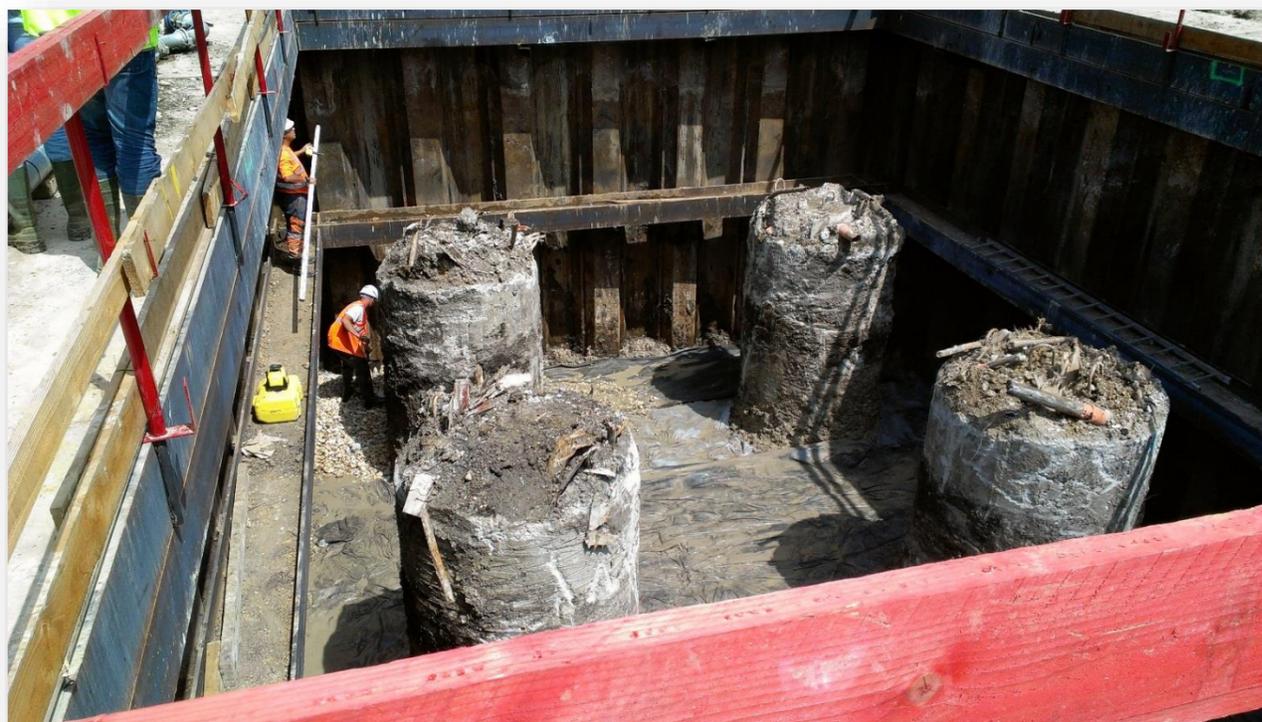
Batardeau pour la réalisation des fondations par pieux forés à sec de la pile P3 du viaduc de l'Austreberthe
